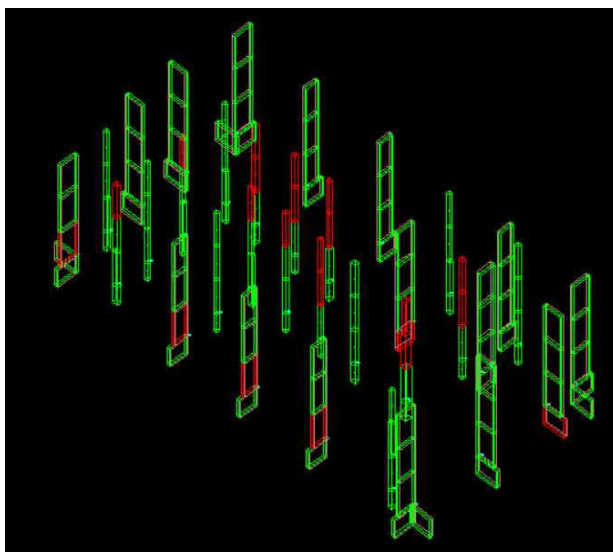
SLV 90% -verifiche pilastri e setti
